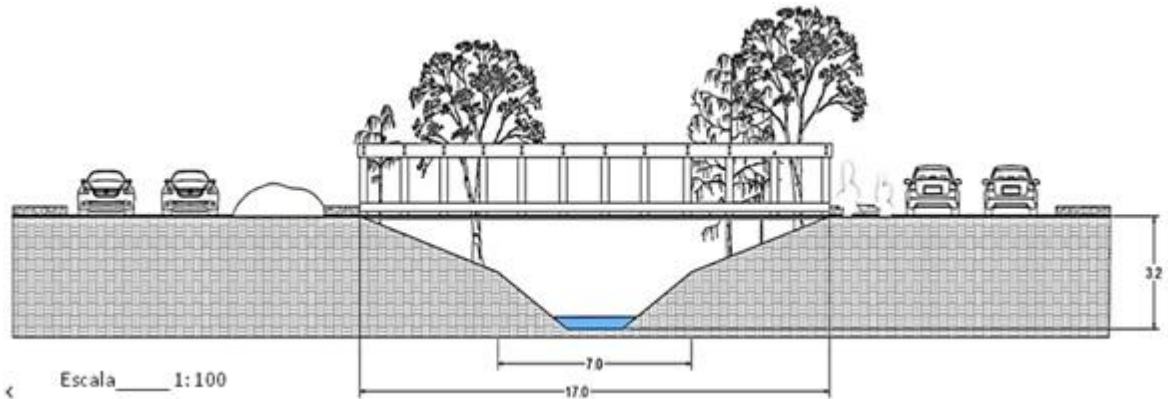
Sección Transversal Cuenca y Canal Quebrada La Picacha. Elaboración: V. Fajardo Castaño y J. Flórez Rendón.
